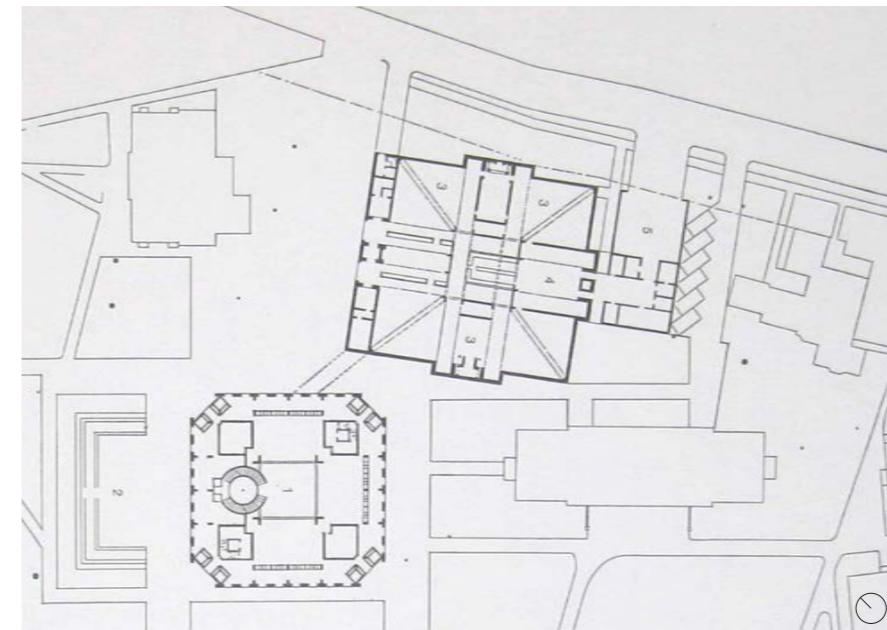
Planta de Implantação de 1967, Louis Kahn.
